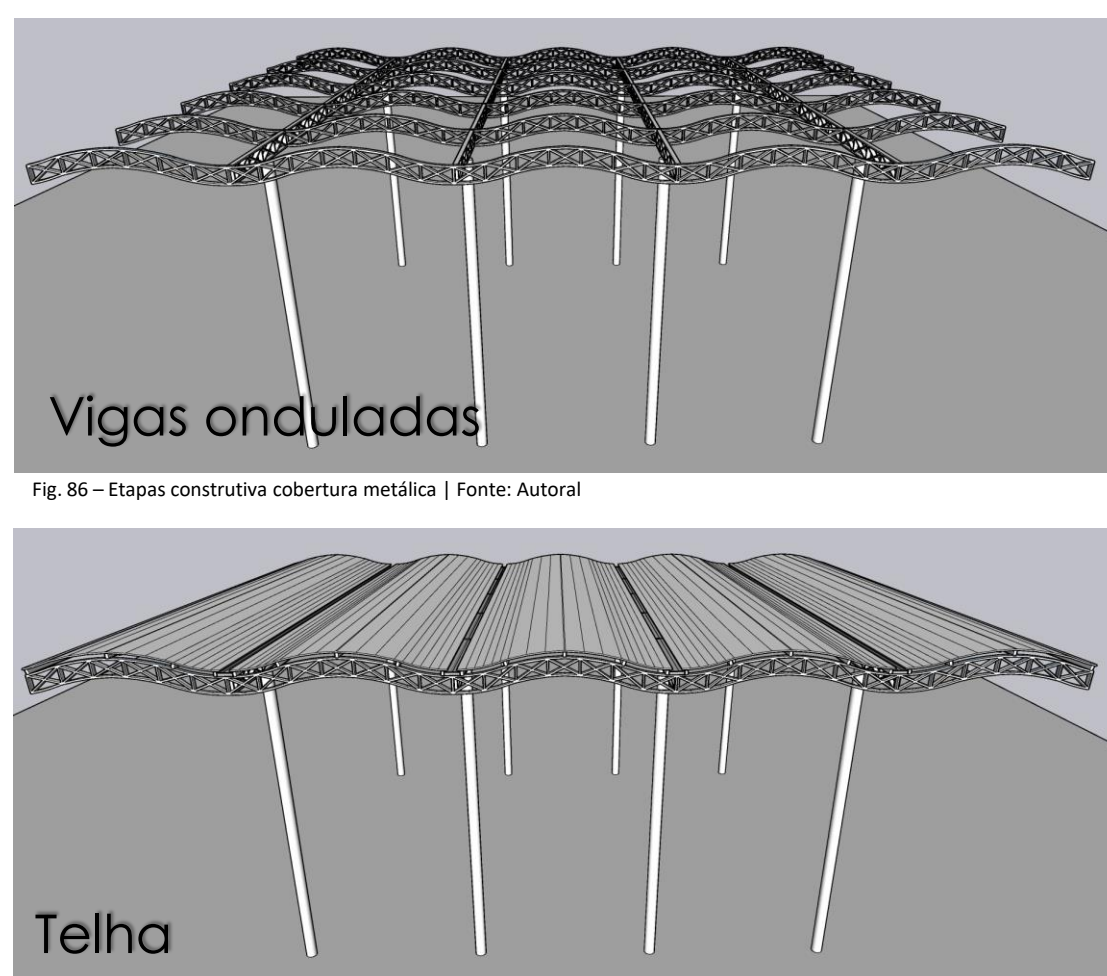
Etapas construtiva cobertura metálica | Fonte: Autora
